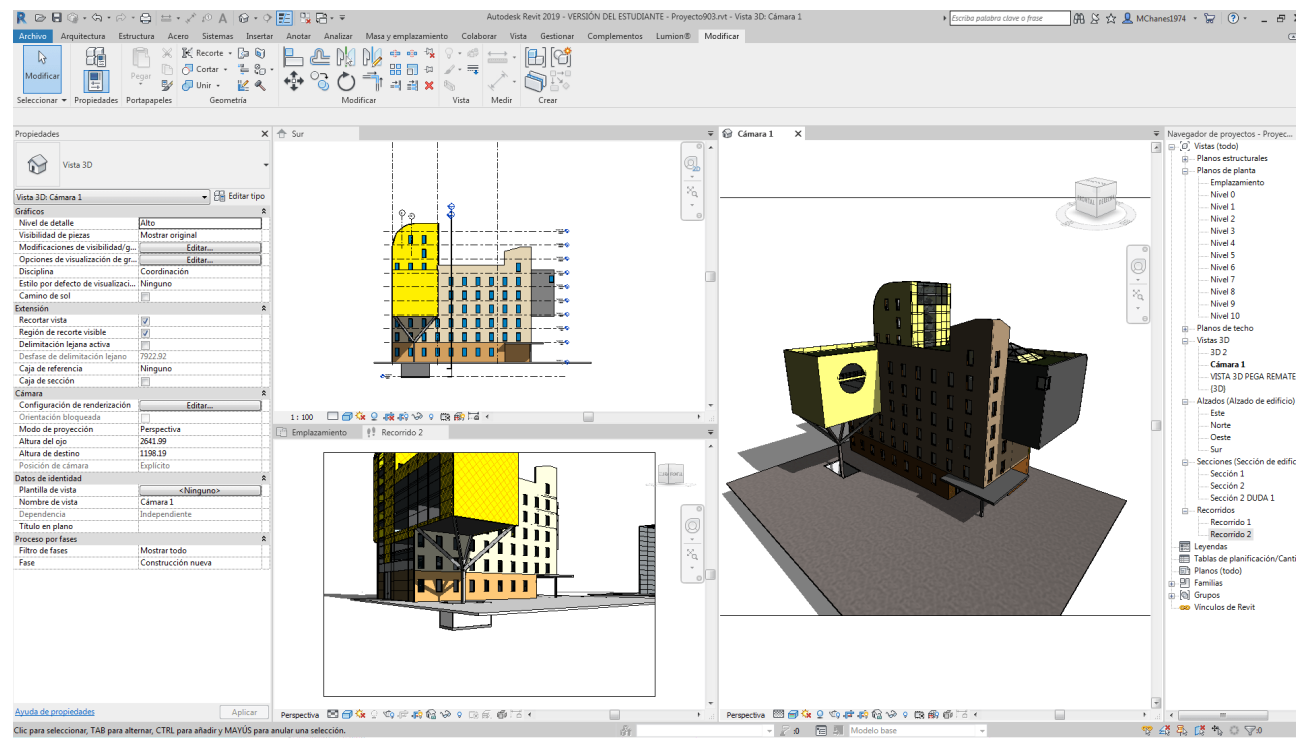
Vistas Revit. (Vistas 3D Por Defecto En Revit, n.d.)
